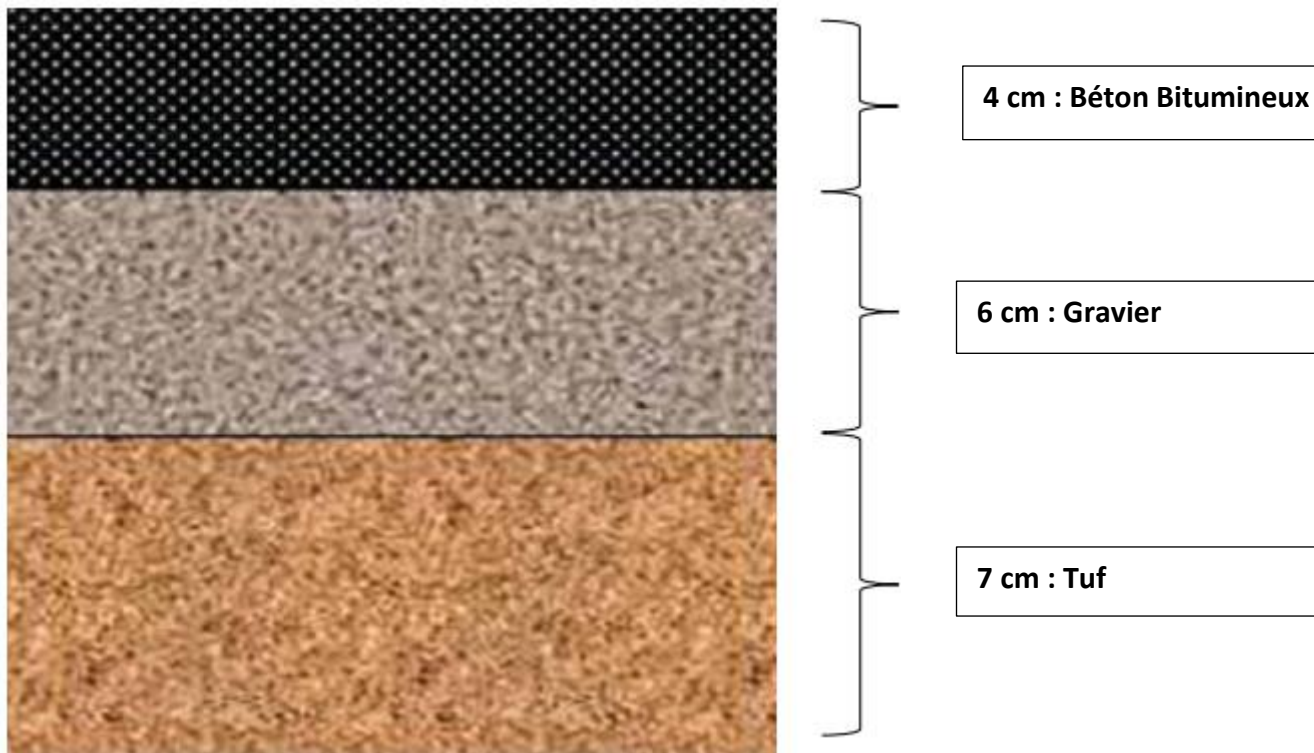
Dimensionnement de la chaussée par la méthode CBR
